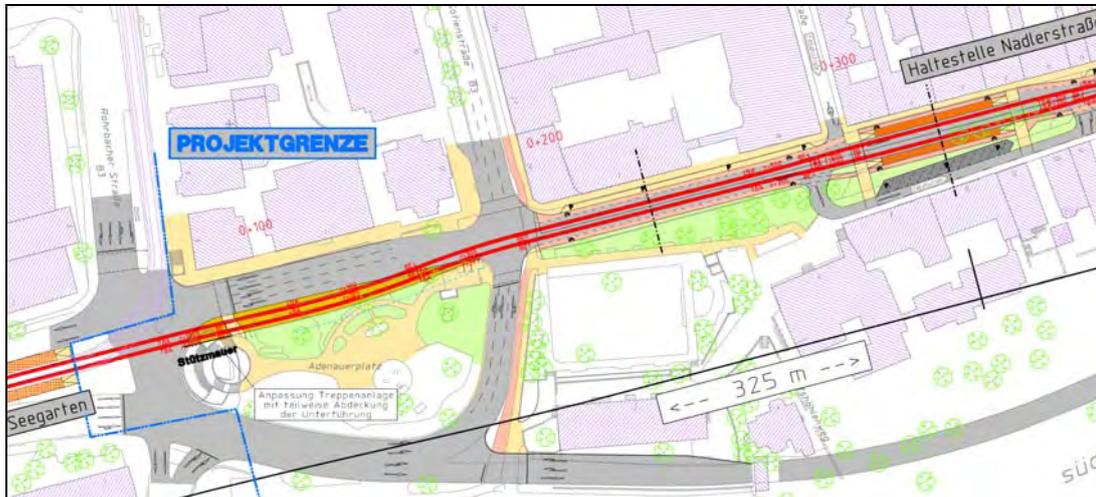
Lageplanausschnitt Adenauerplatz bis Haltestelle Nadlerstraße (Variante 2)
